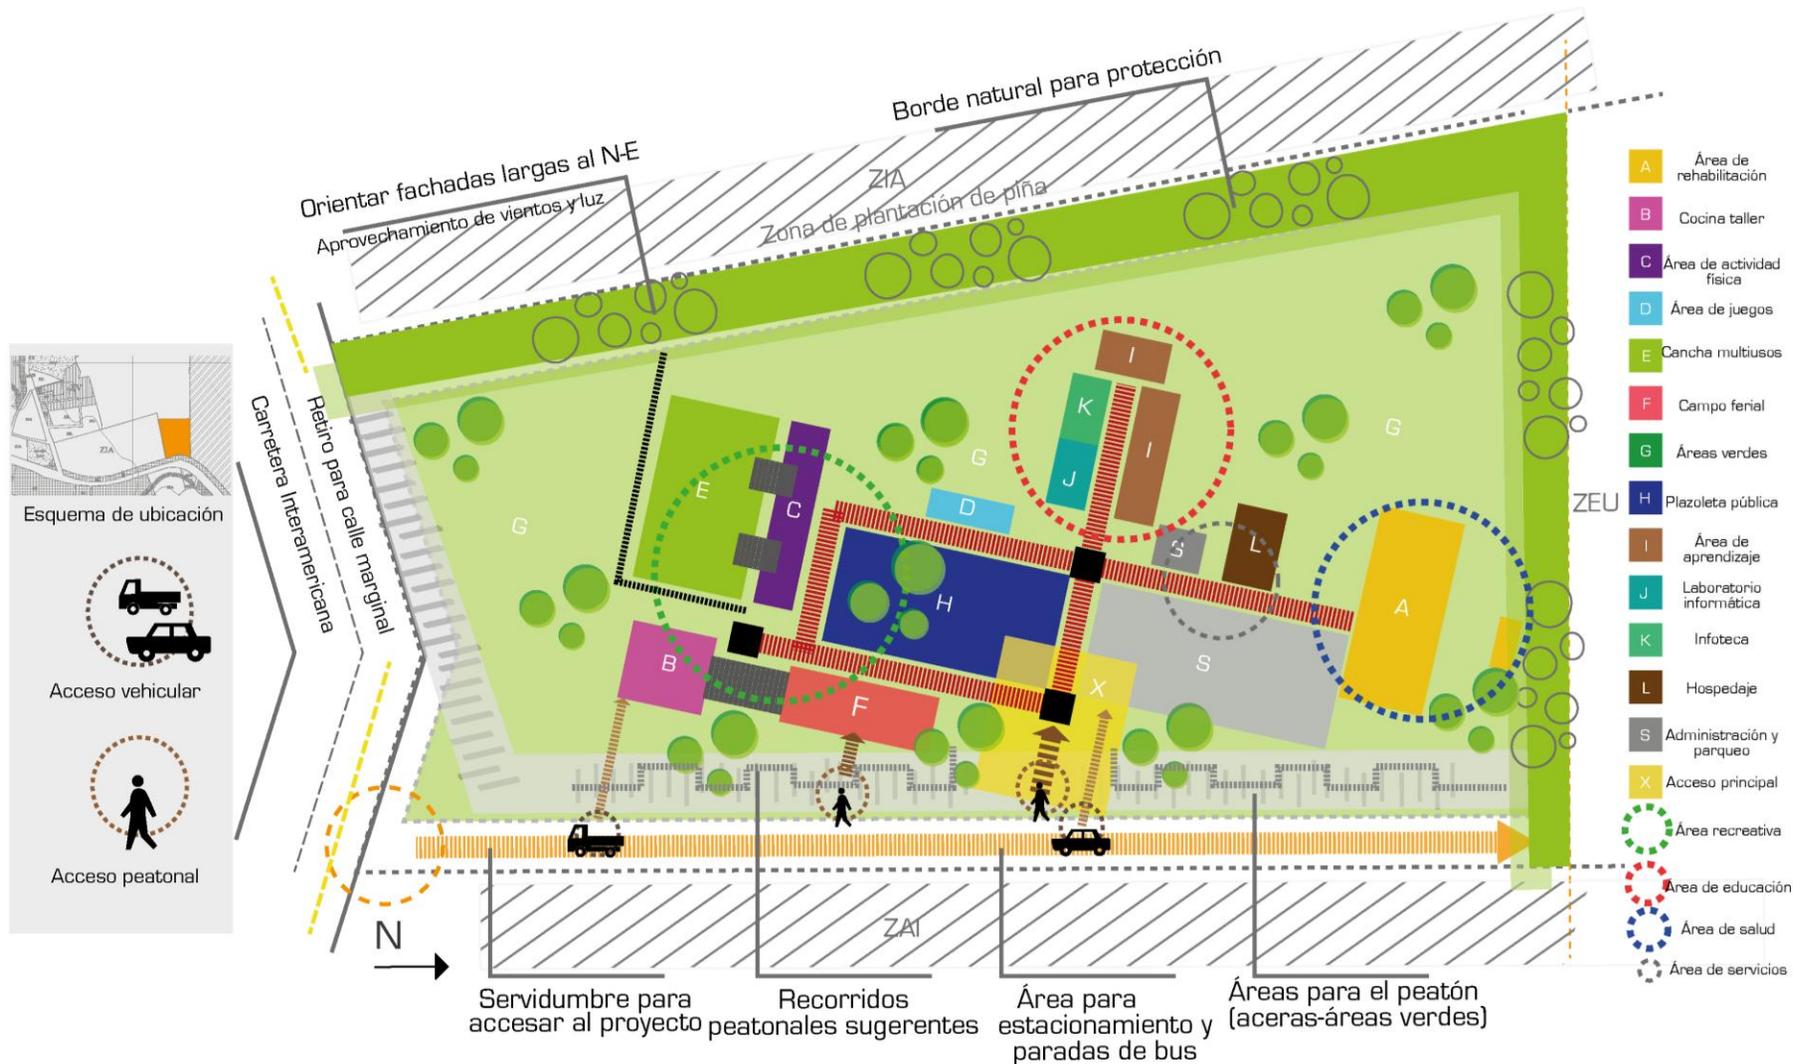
Plan de zonificación conceptual del proyecto. Fuente: Elaboración propia
